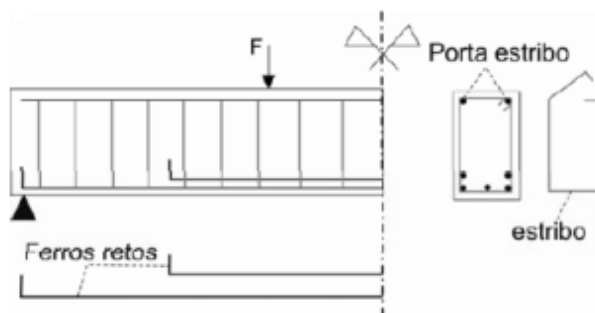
Armaduras longitudinais (reta) + armadura transversal (estribo) (MARINS *et al.*, 2001).
